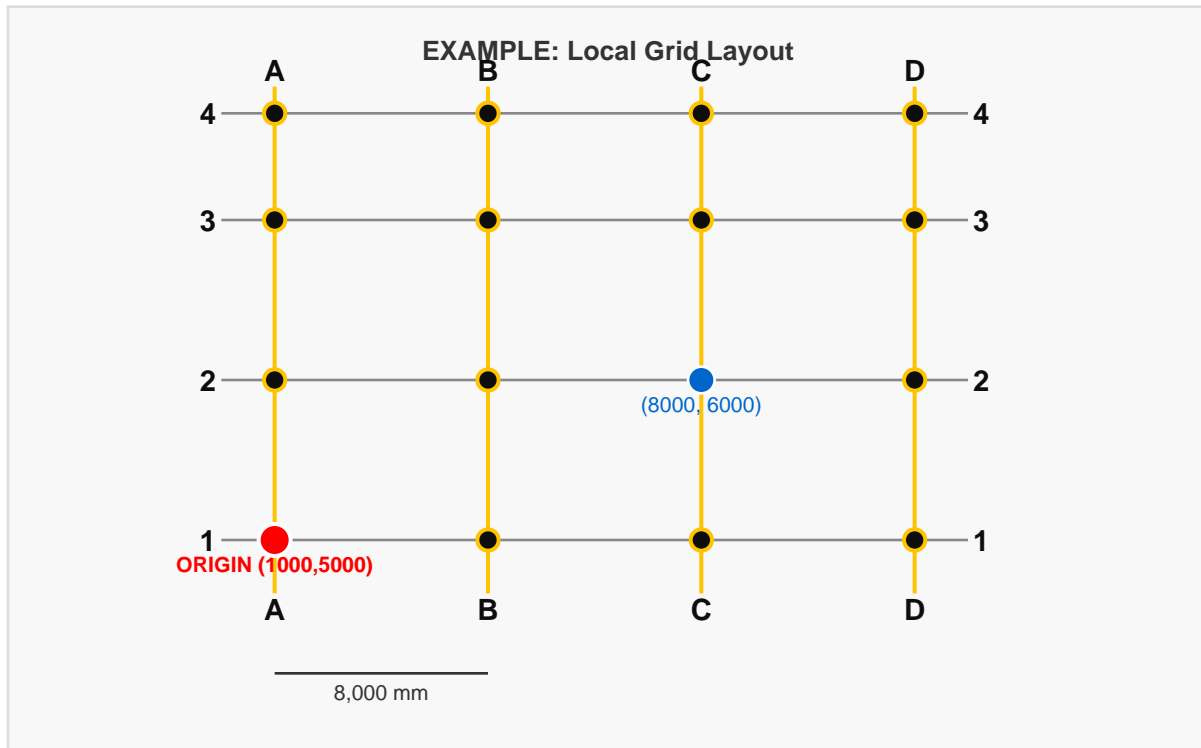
Ejemplo de un sistema de coordenadas locales en un sitio de construcción
